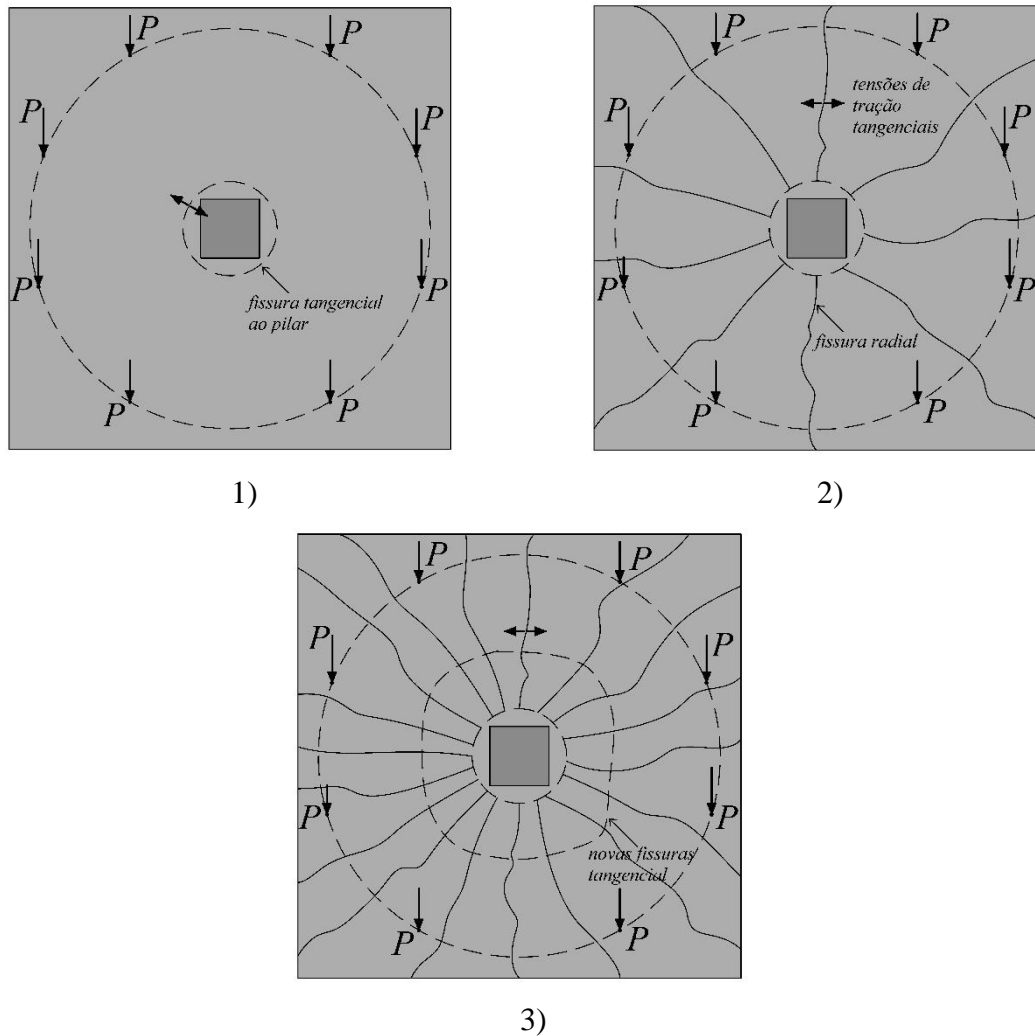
Processo de formação de fissuras de punção. 1) fissura tangencial formada por tensões radiais; 2) fissuras radiais formadas por tensões tangenciais; 3) estágio final de ruptura à punção de laje lisa.
